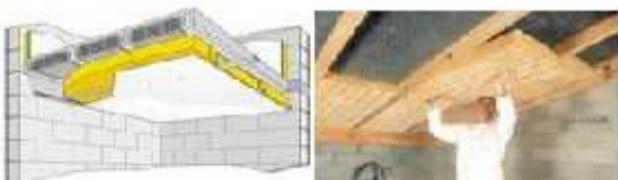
Fig VI : isolation acoustique des dalles par la 'laine de roche anti-feu' entre la dalle et le faux-joufflage
